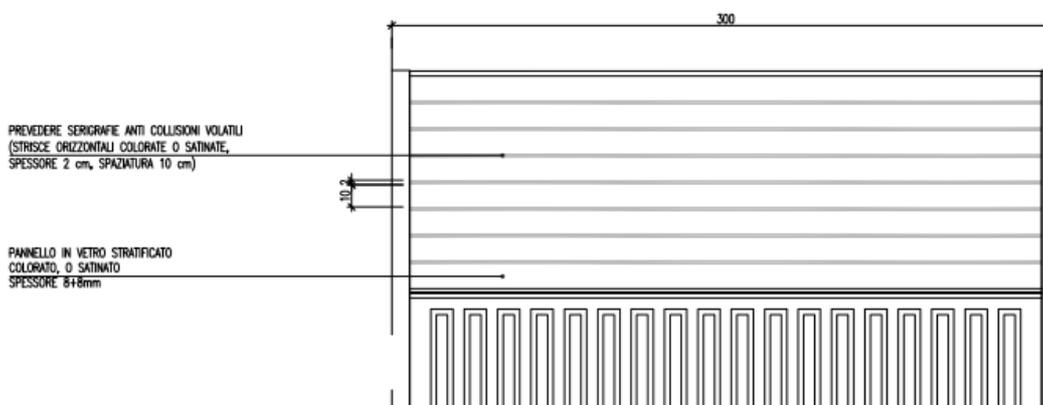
Particolare barriere acustiche vetro - – Stralcio elaborato 2.6-dF.1.8.01
